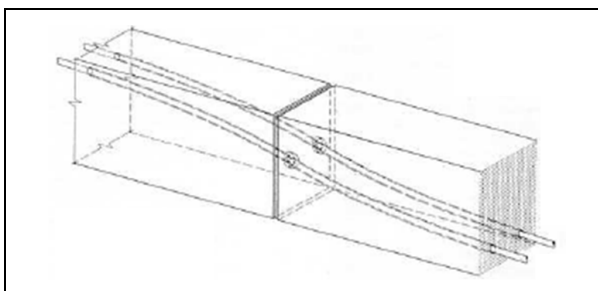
Ligação por pré-esforço (Stupré, 1981)
